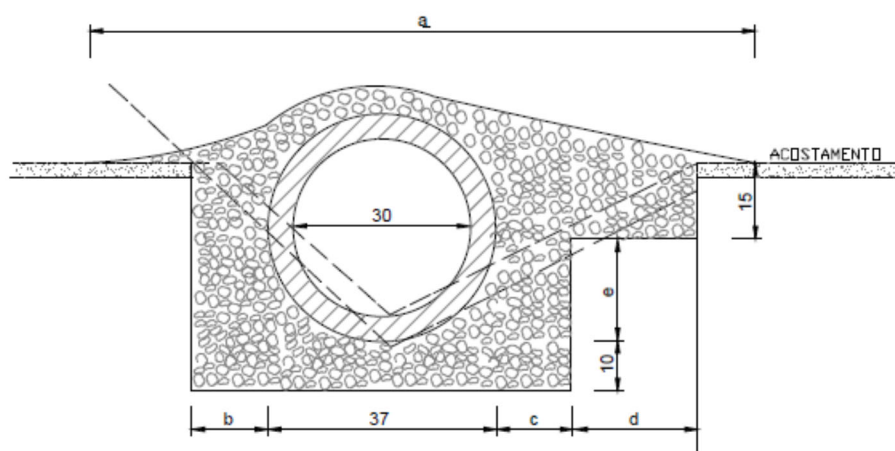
Seção transversal do dispositivo TSS-Tipo 2 e Tipo 4.
